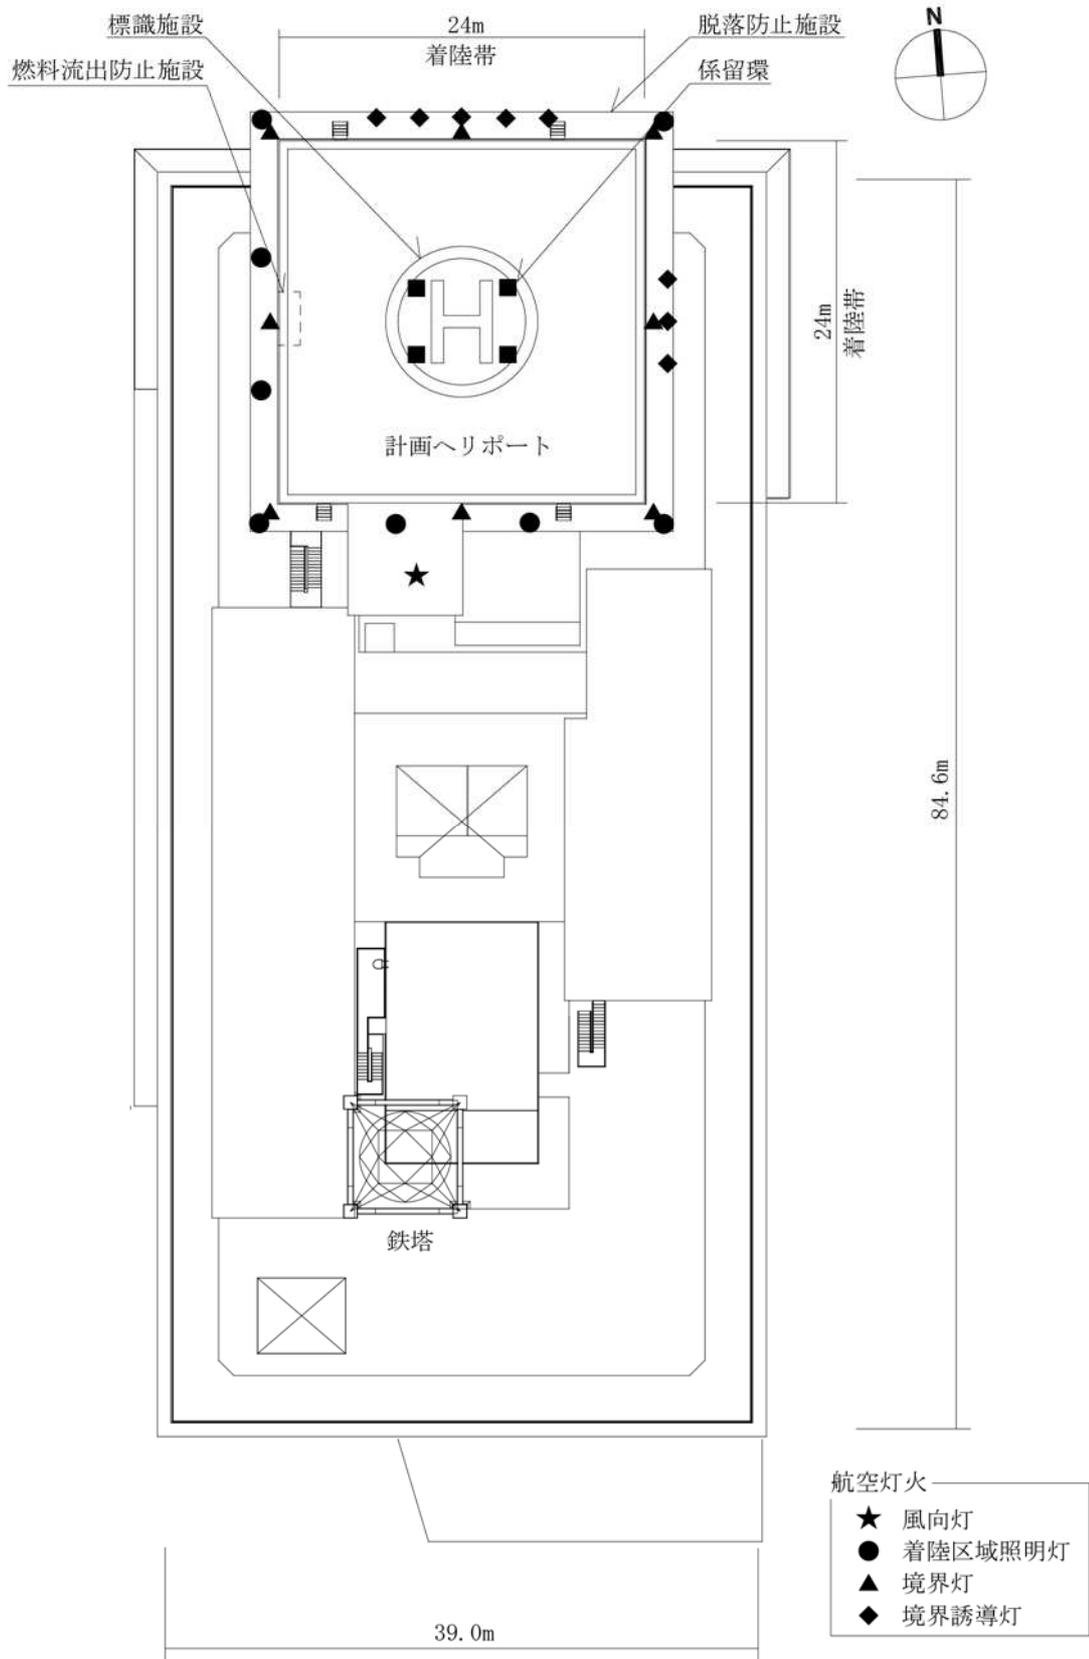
計画ヘリポート設置建築物と計画ヘリポート平面図
